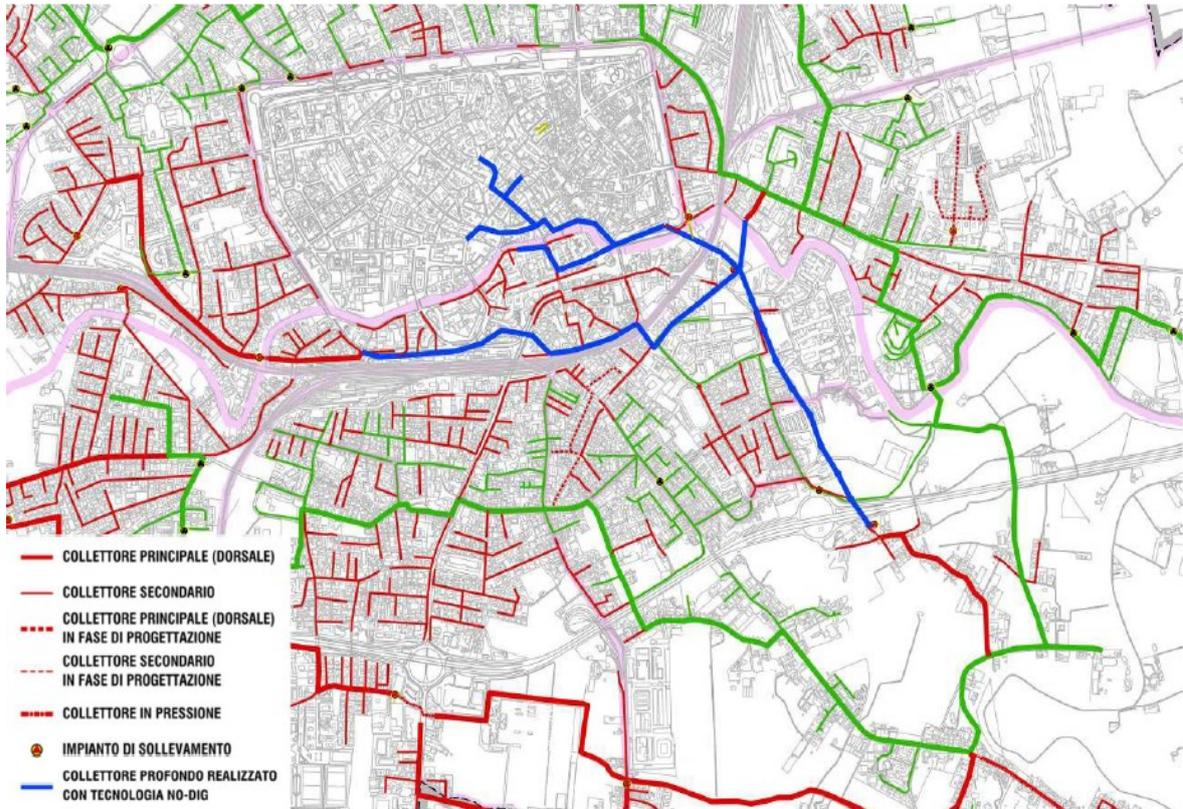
Planimetria di progetto con dorsali realizzate con tecnica no-dig.
